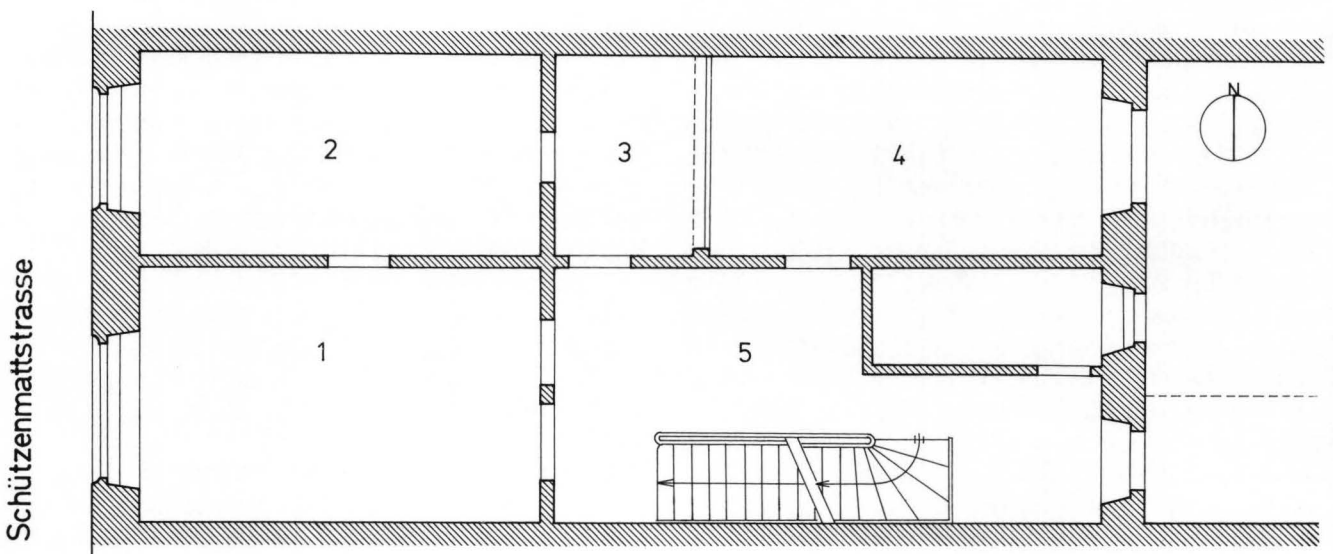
Grundriss des 1. Stocks. Die beiden durchgehenden Trennwände gehen auf 1545 zurück. – Zeichnung: F. Goldschmidt. – Massstab 1:100.
